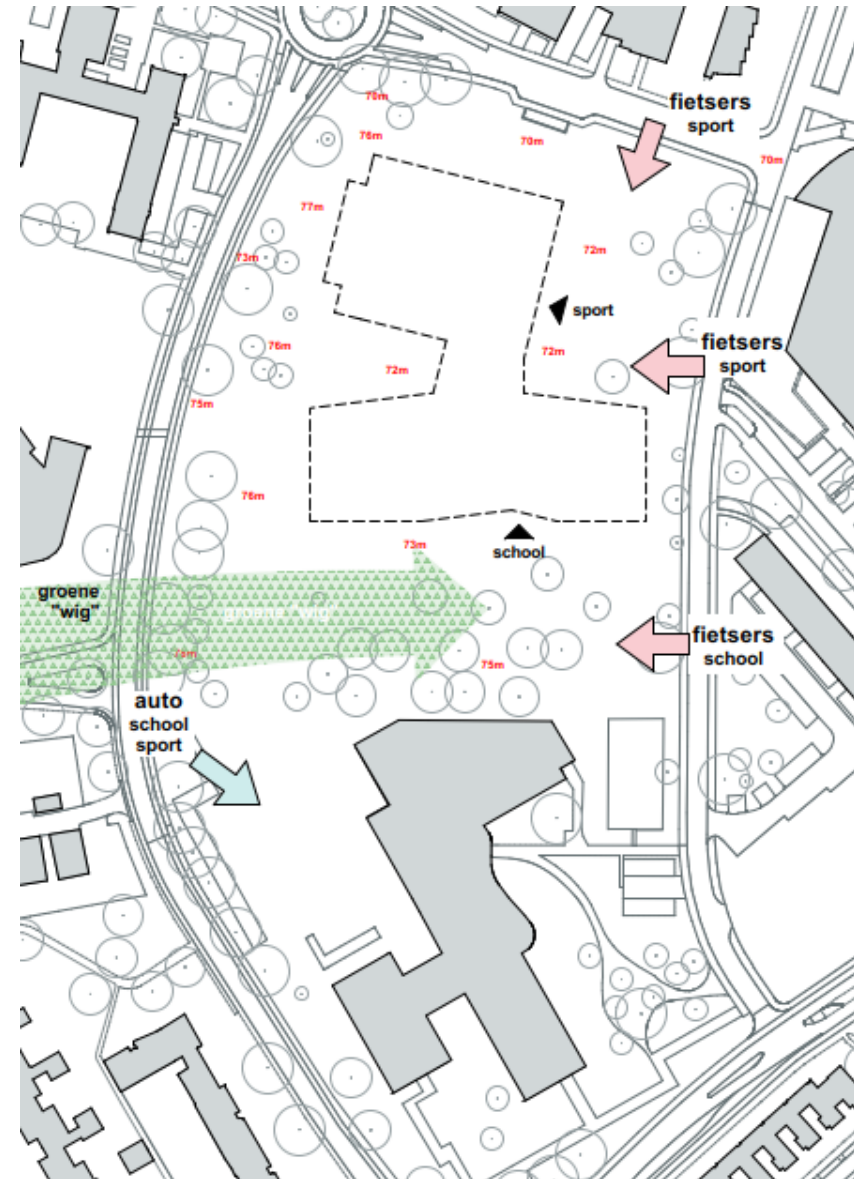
Stedenbouwkundig schema met groenstructuren, fiets- en autoverkeerstromen en het bouwvlak (cf. vigerend bestemmingsplan) in zijn omgeving
